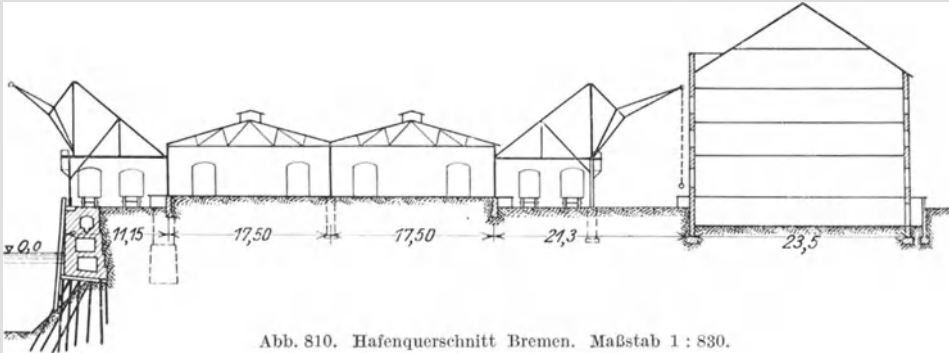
Hafenquerschnitt Bremen. Maßstab 1 : 830.
